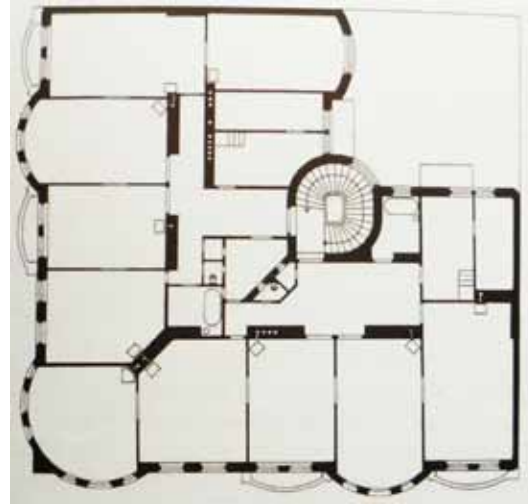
Grundriss, Untere Viaduktgasse Nr. 8
